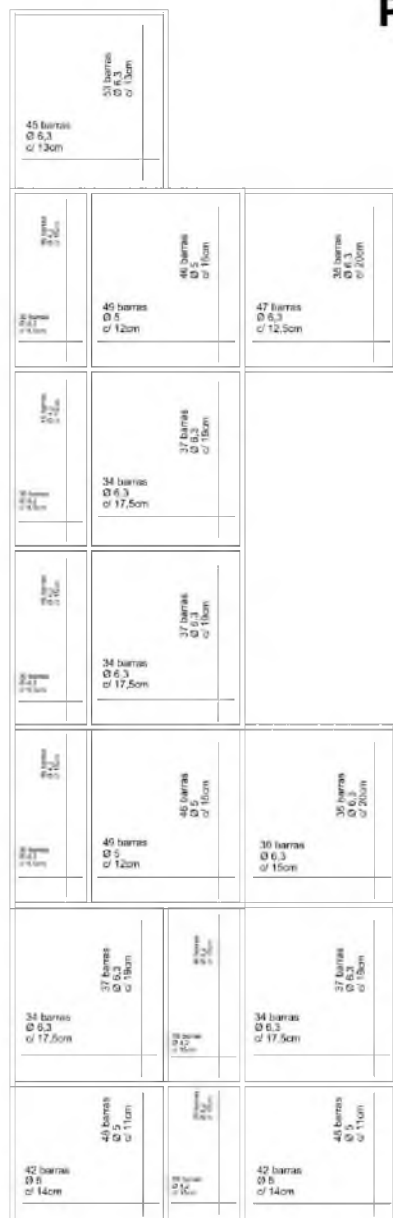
Detalhamento das armaduras negativas das lajes do primeiro pavimento
